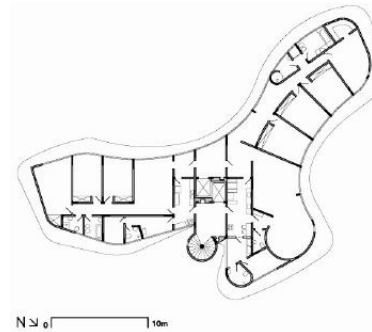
Planta de pavimento tipo do Edifício Niemeyer. Fonte: Copeve – UFMG.
